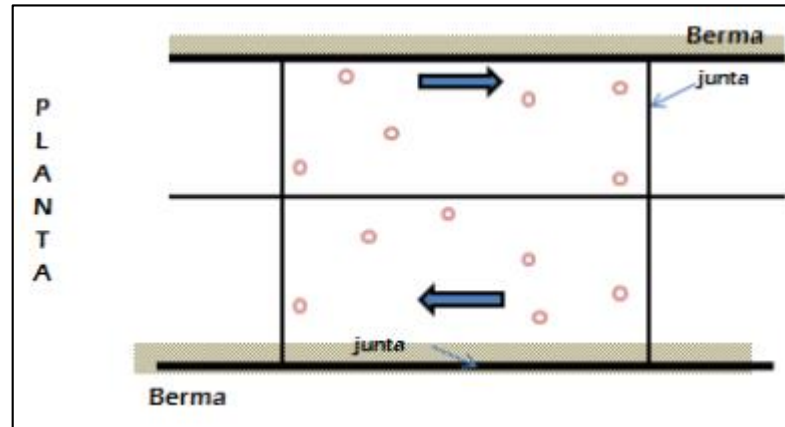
Esquema de la vista en planta de desintegración (popouts).
